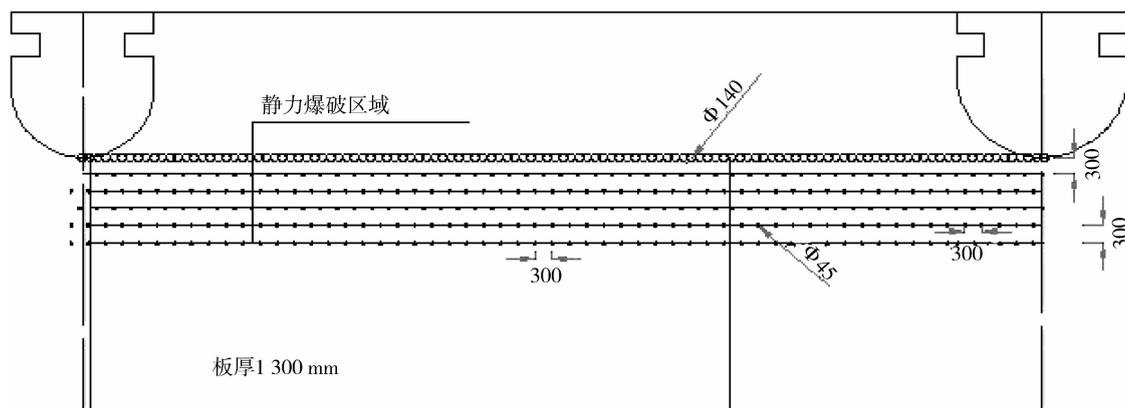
静力爆破拆除孔位布置平面示意(单位:mm)
